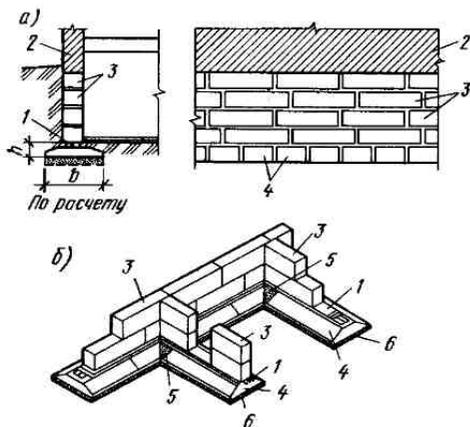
Ленточный сборный фундамент из крупных блоков:
